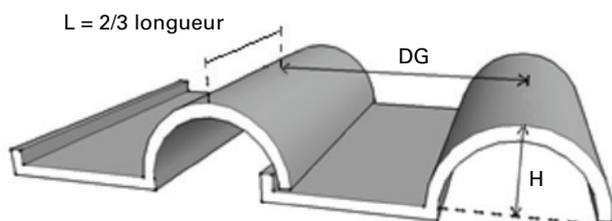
Prise de dimensions sur les tuiles pour définir le galbe
